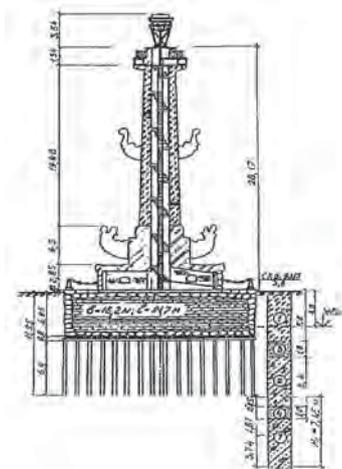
Схема свайного фундамента под Ростральные колонны
